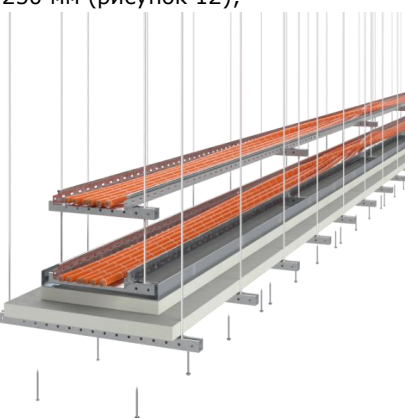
Установка монтажного уголка DG3030 или DG6060 при помощи саморезов
